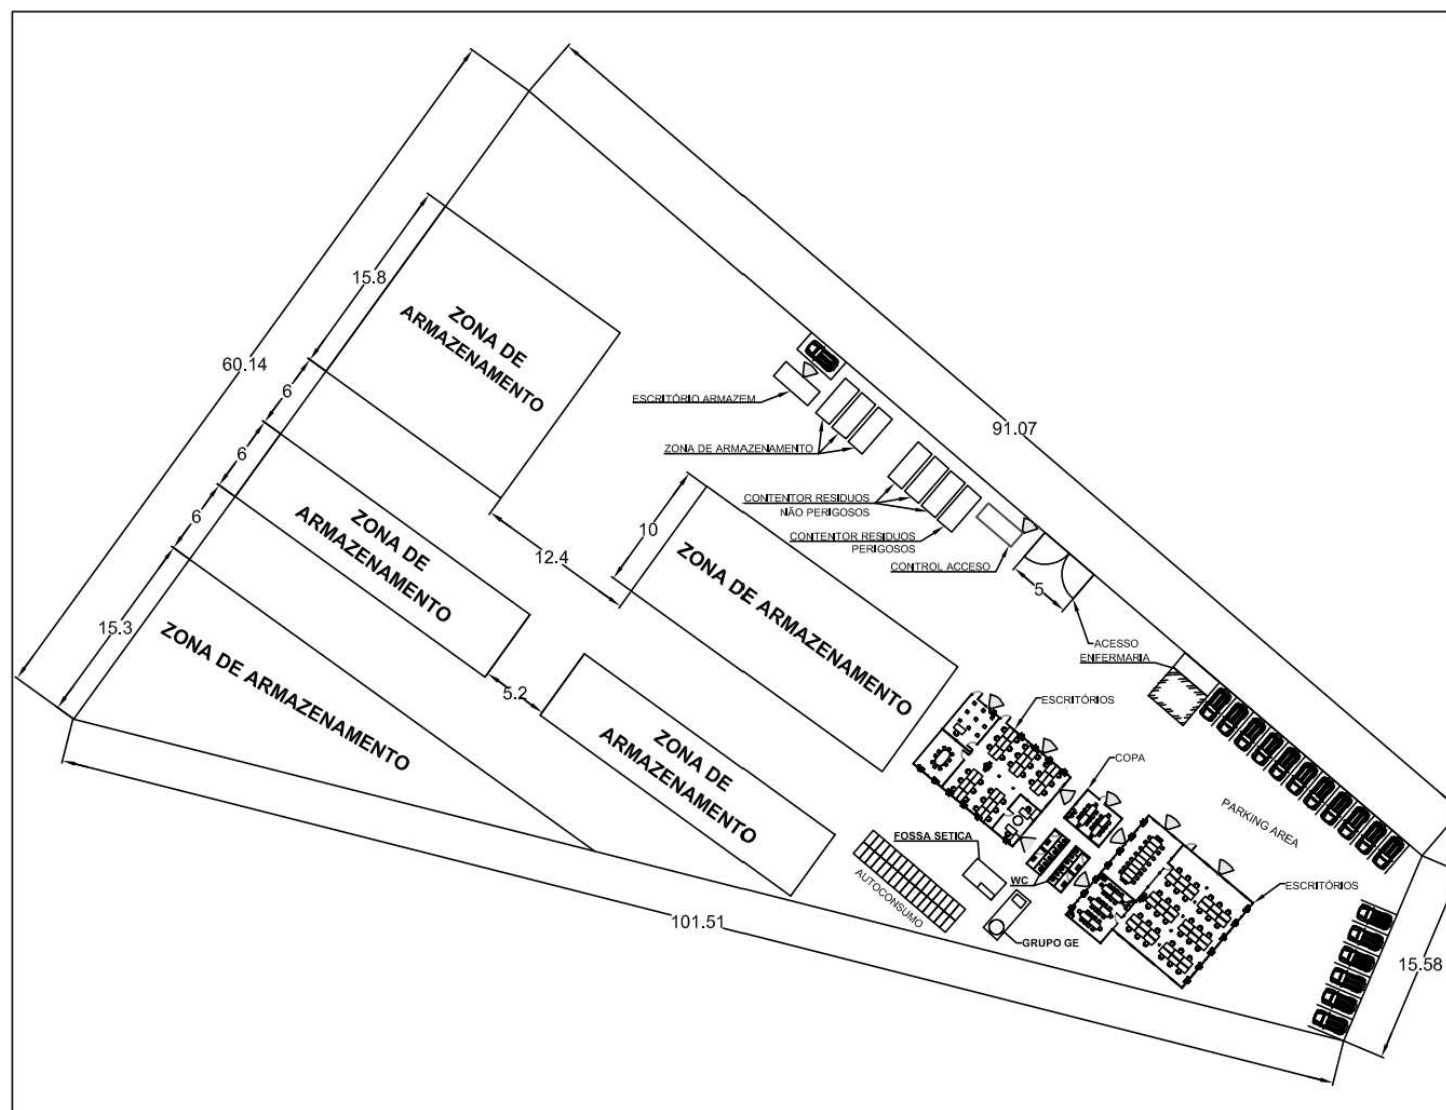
Plano do estaleiro a ser utilizado durante a fase de construção da CFA
